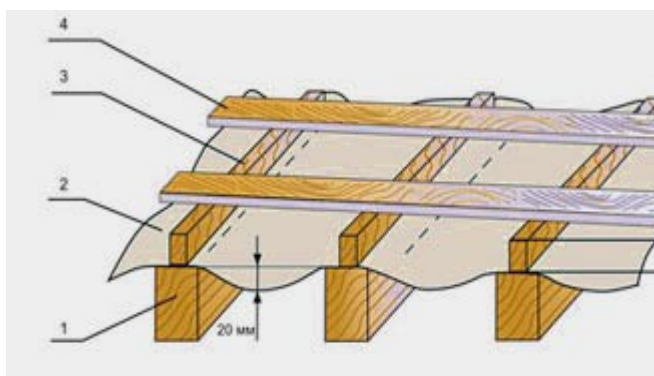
Укладка гидроизоляционной плёнки и обрешётки: 1 — стропильная нога; 2 — гидроизоляция; 3 — стропильная планка (брус контробрешетки); 4 — обрешётка.
